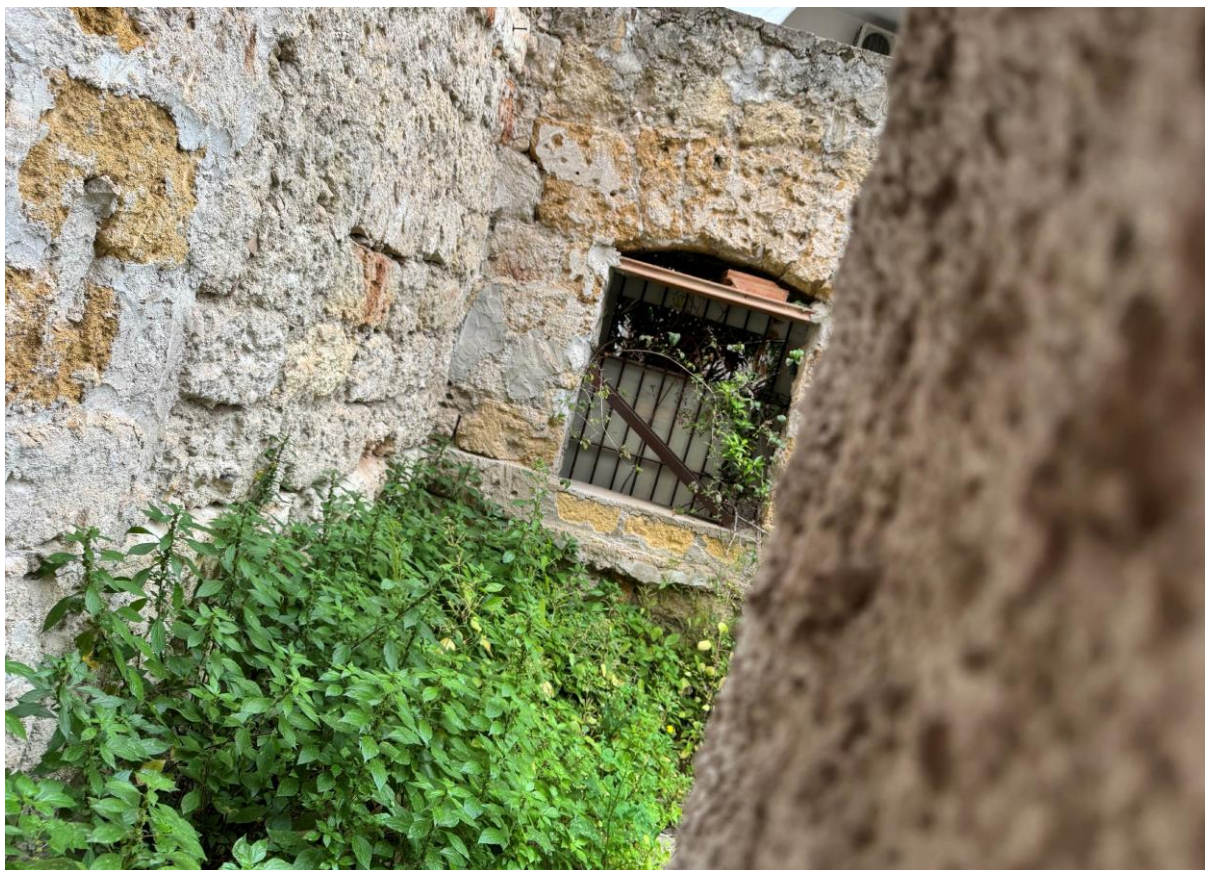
Interno fotografato dalla finestra del WC senza copertura e senza pavimento, si vede la parete esterna in blocchi di tufo
